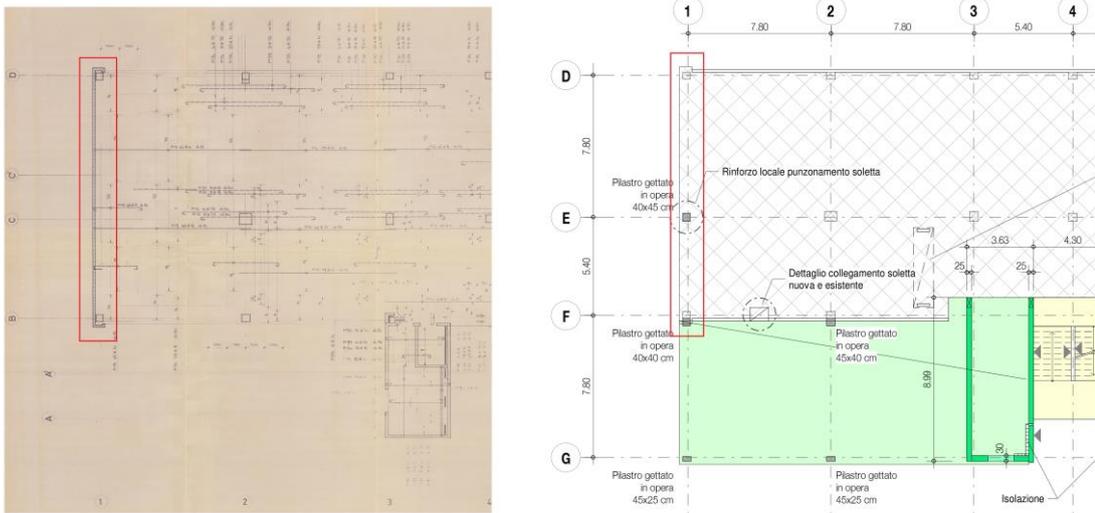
Dettaglio Asse 1 a sinistra situazione attuale con muro in facciata, a destra situazione finale con pilastro in facciata.
